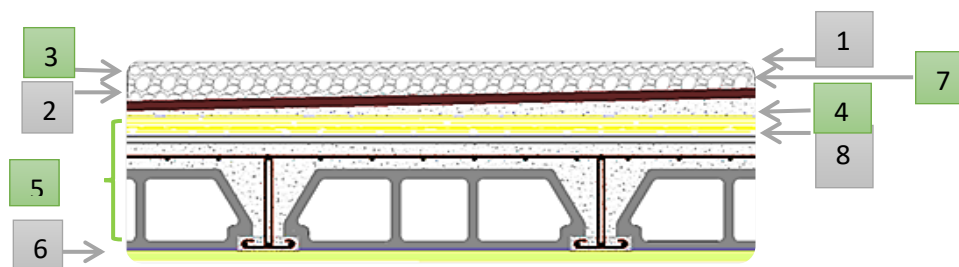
Composants d'un plancher terrasse en corps creux.
